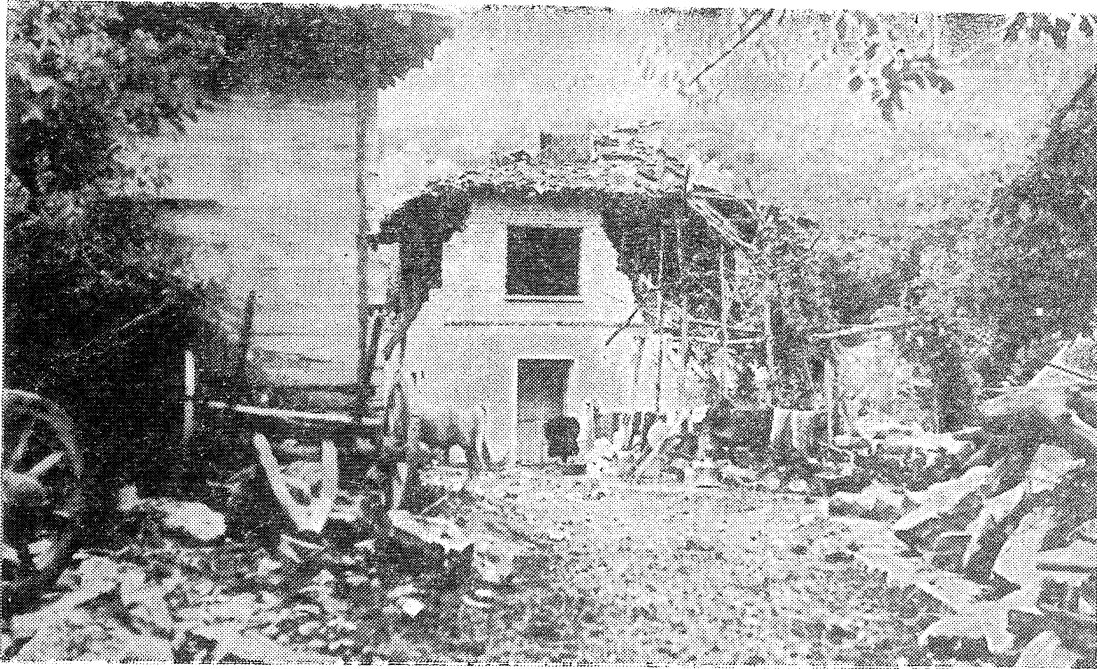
Kirlik köyü Horas mahallesinde fazla hasar görmüş bina.
